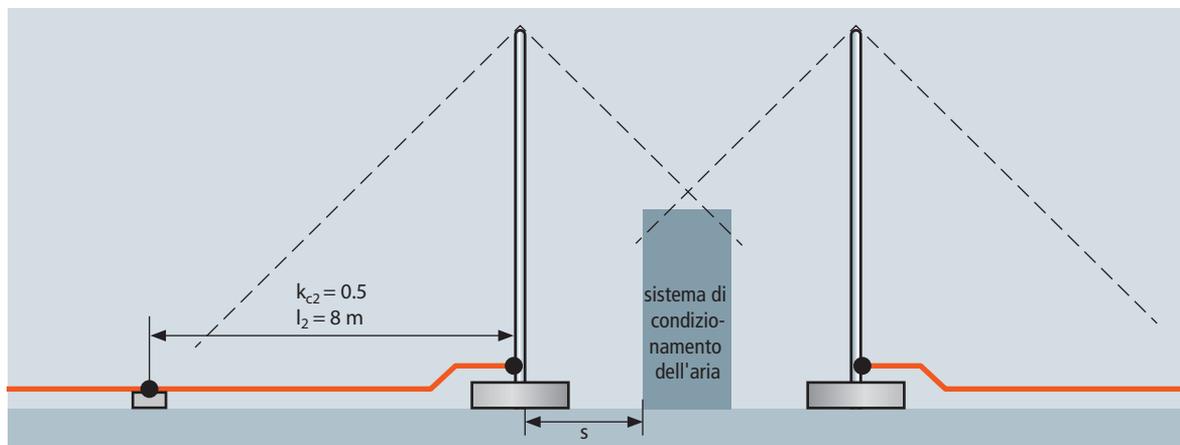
Esempio: struttura installata su un tetto; sistema con più calate
